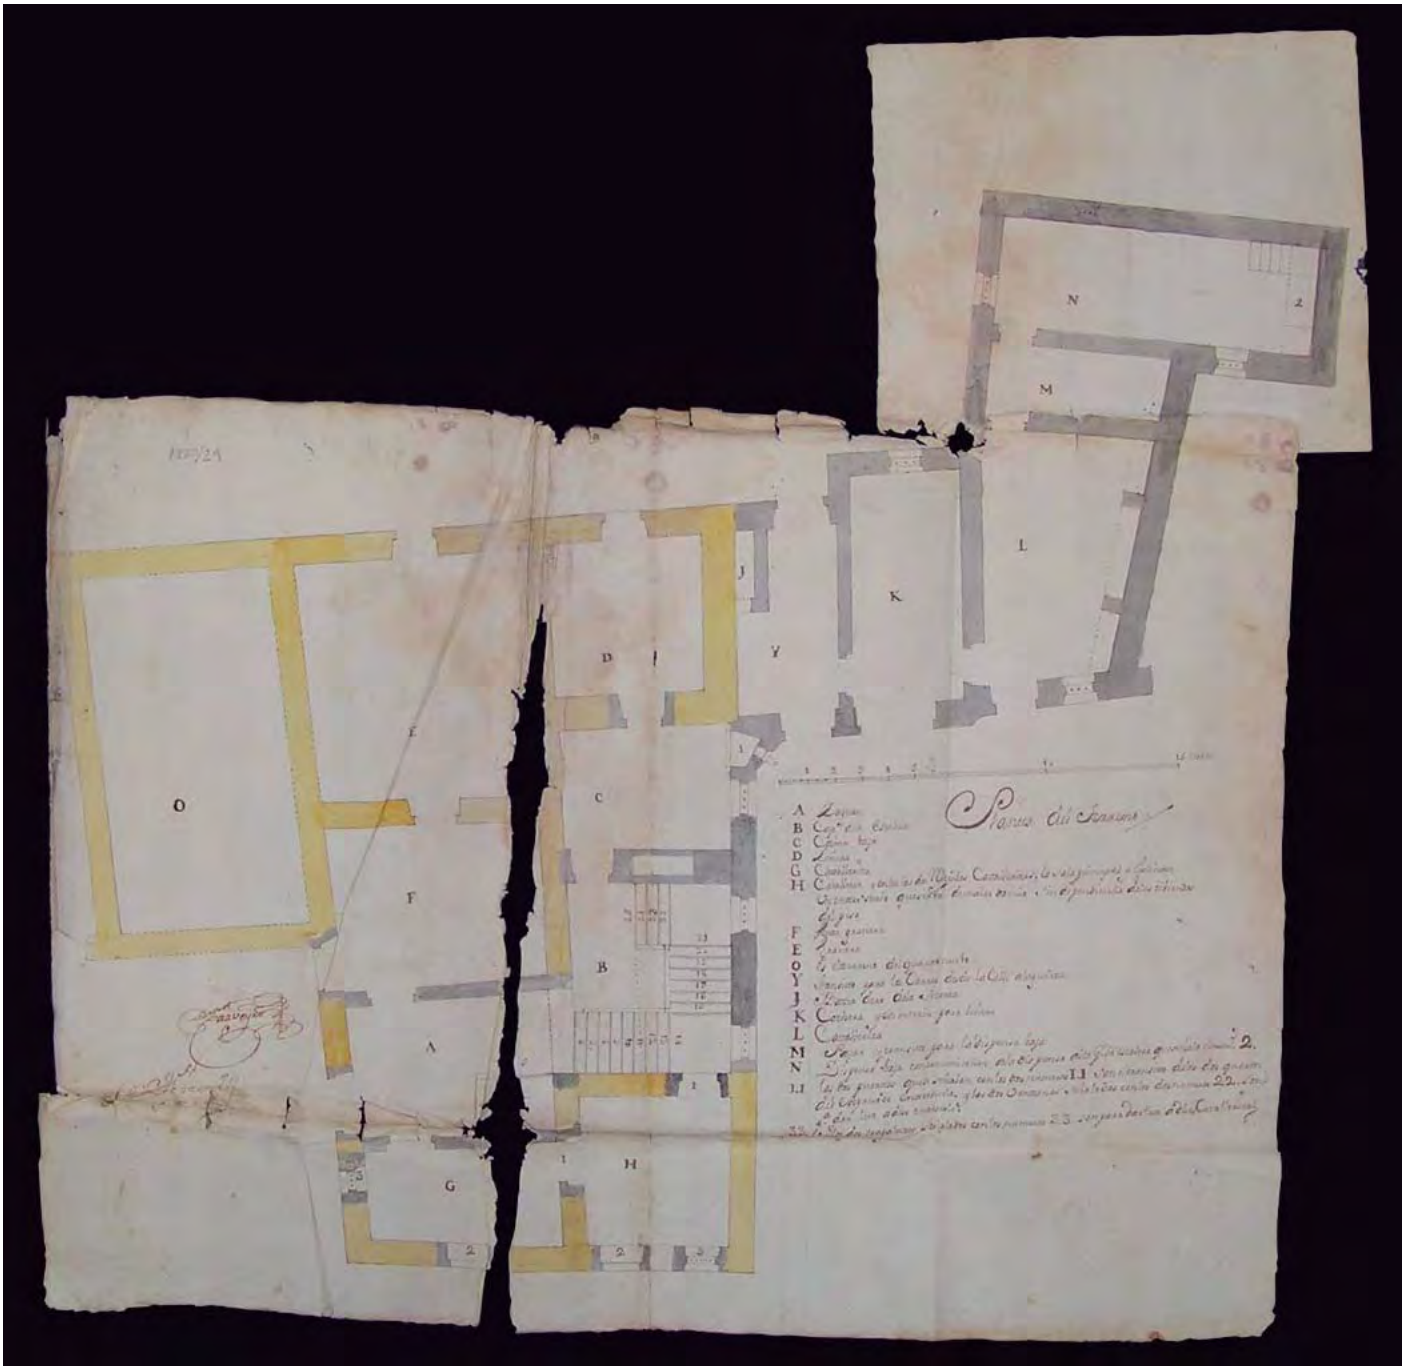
Plano de la planta baja de la casa de Joaquín de Lamas. Lucas Ferro Caaveiro. Ca. 1745. Archivo de la Diputación de Pontevedra, Fondo Caamaño, caja 1.220, exp. 29
